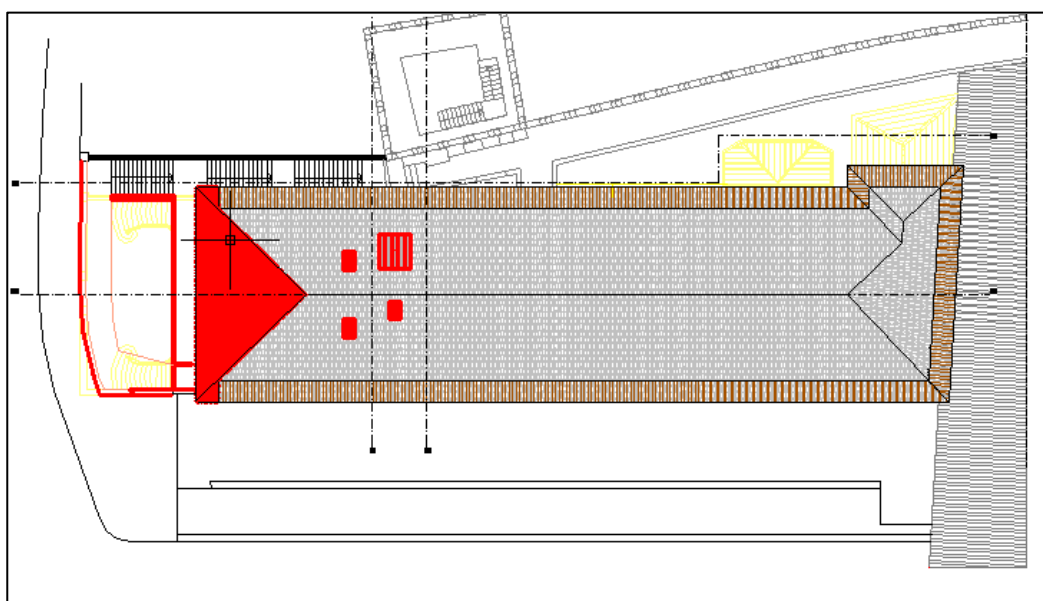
Planta da cobertura (existente e proposto) [22]
